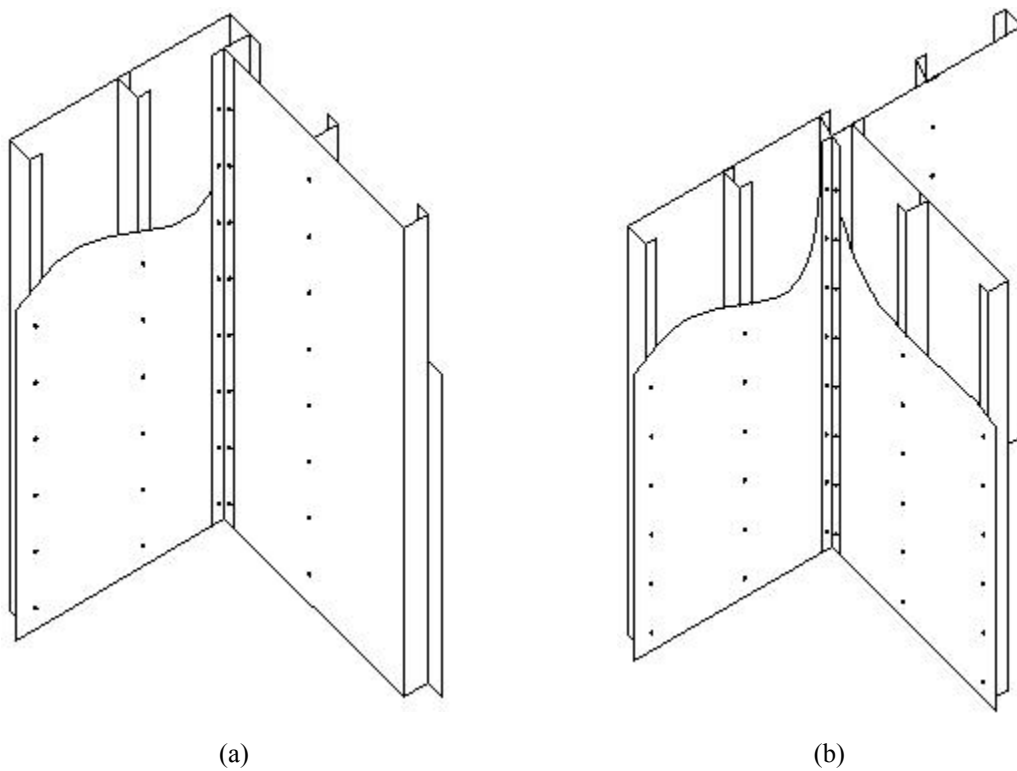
Detalhe da ligação entre paredes perpendiculares: (a) canto em L; (b) canto em T.
